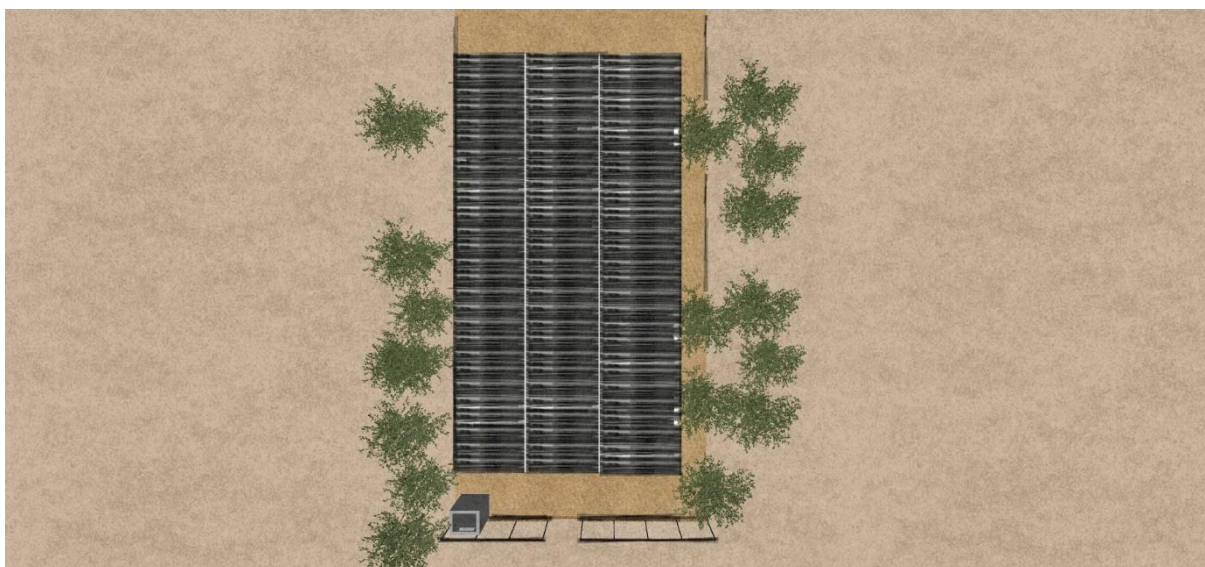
Vivienda tipo comercio en San Isidro – *vista planta*. Fuente propia
